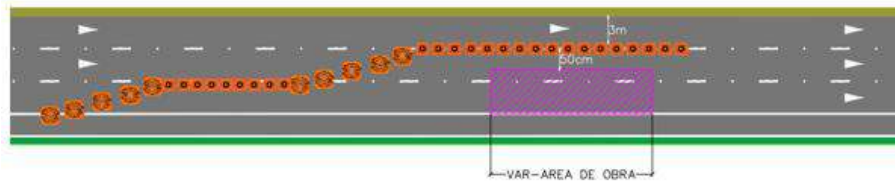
Posicionamento de dispositivos de canalização – Pista com 3 faixas (caso 2)
